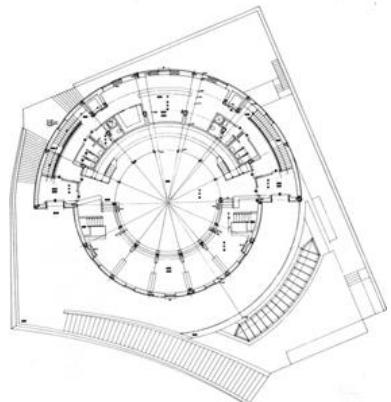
Planta piso superior, Biblioteca Pedro Salinas, Madrid (Planta)
